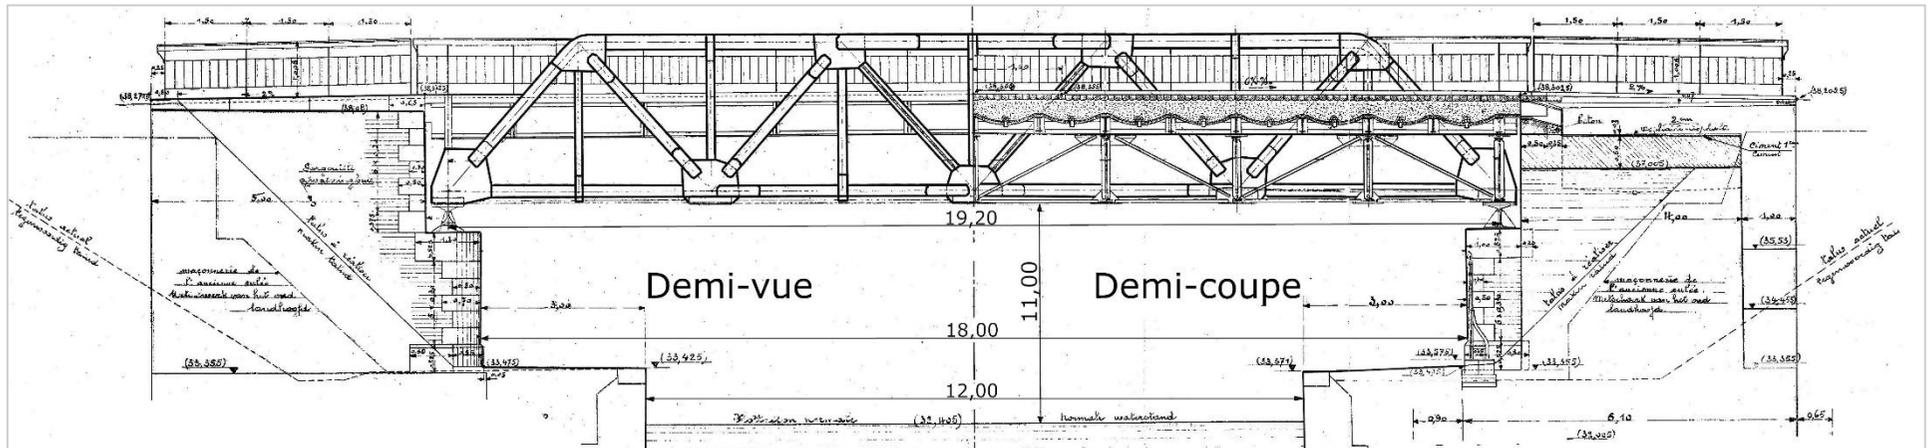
Vue en élévation et coupe longitudinale du *Pont Royal* de Maubray de 1926 (Extrait des plans originaux<sup>11</sup> : archives du SPW Liège)
